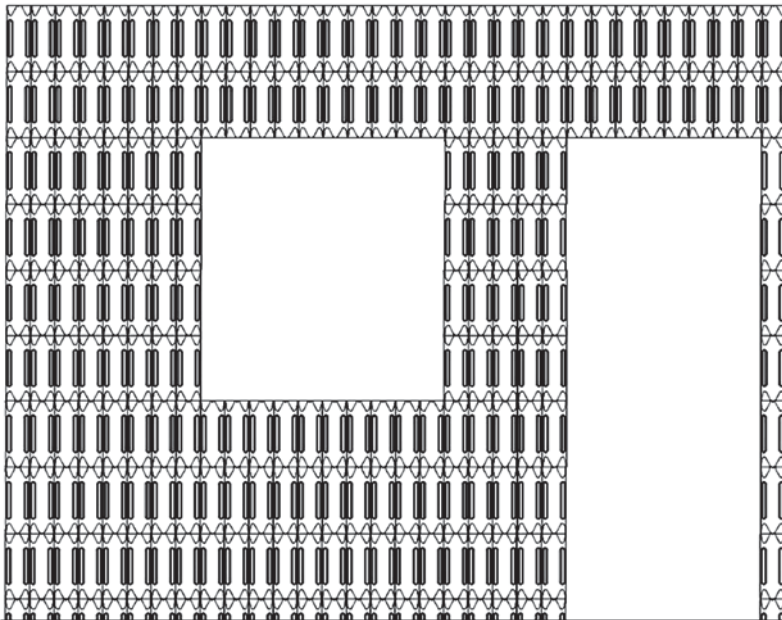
Parede construída com destaque para as aberturas de portas e janelas
